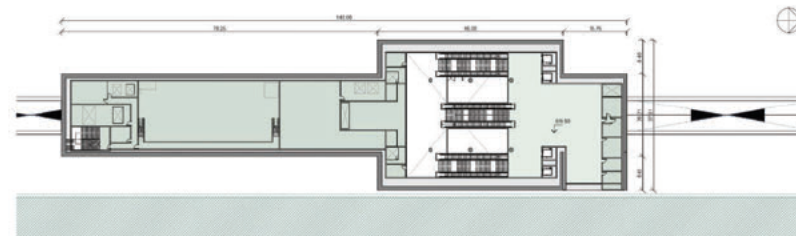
Estación Barajas T4 \_Planta Vestíbulo
